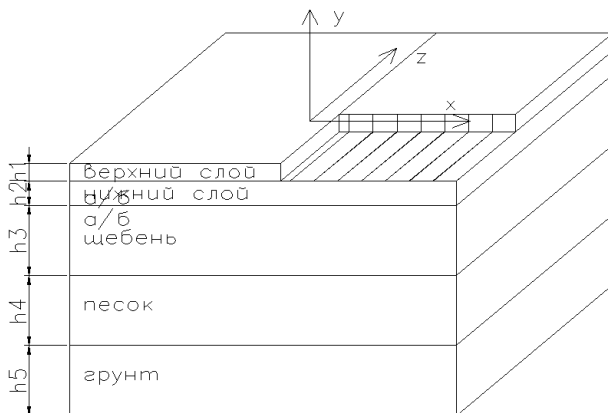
Расчетная схема укладки дорожного покрытия несколькими асфальтоукладчиками
